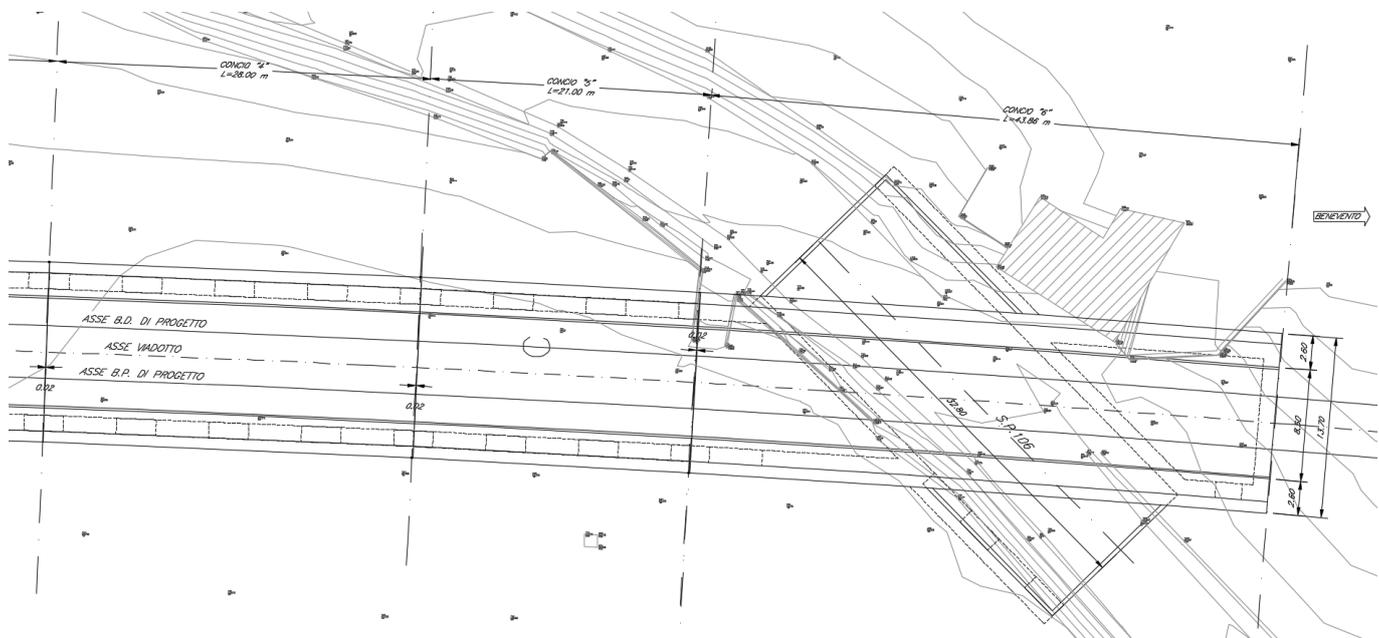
Stralcio planimetrico del VI14 – 2 di 2
